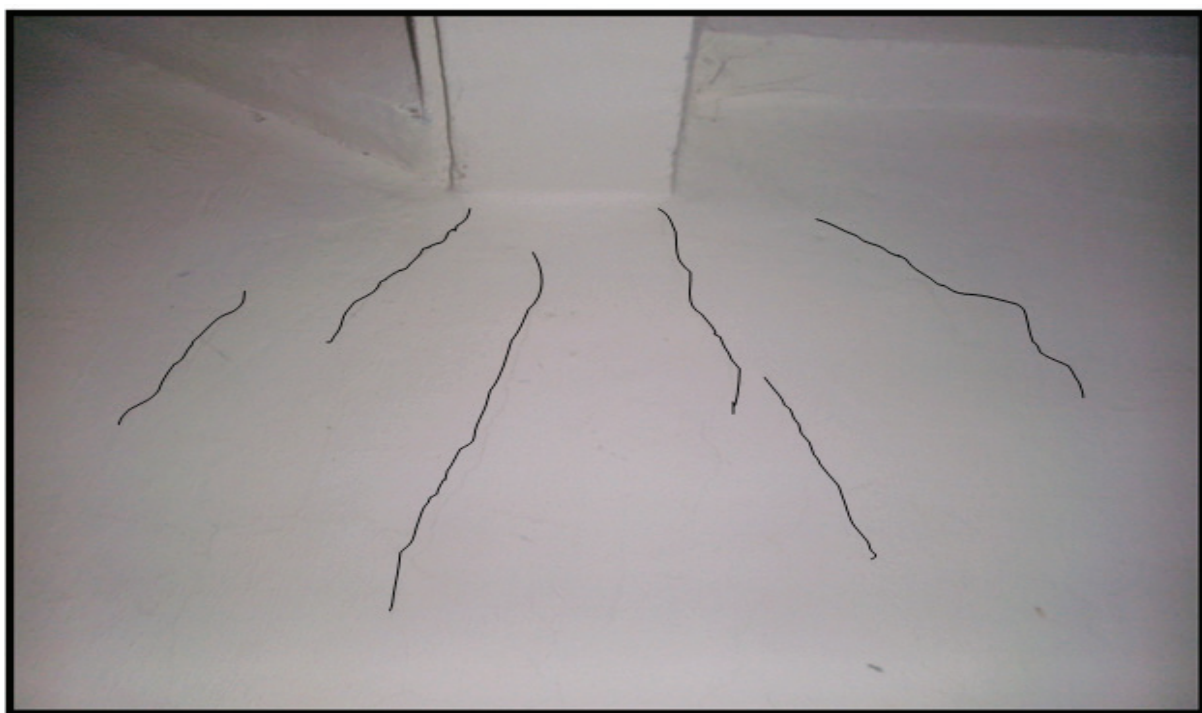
Вертикальные трещины шириной раскрытия до 7 мм в наружной стене. Локальные участки замачивания балконных плит
